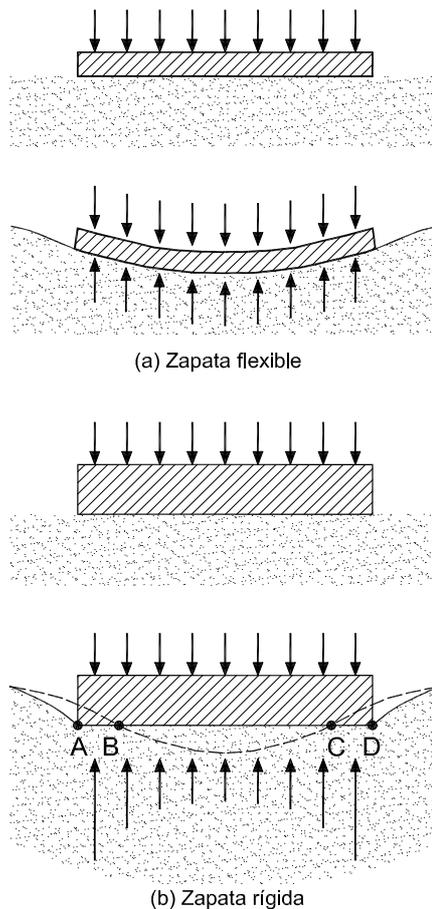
Distribución de presiones en cimentaciones flexibles y rígidas
